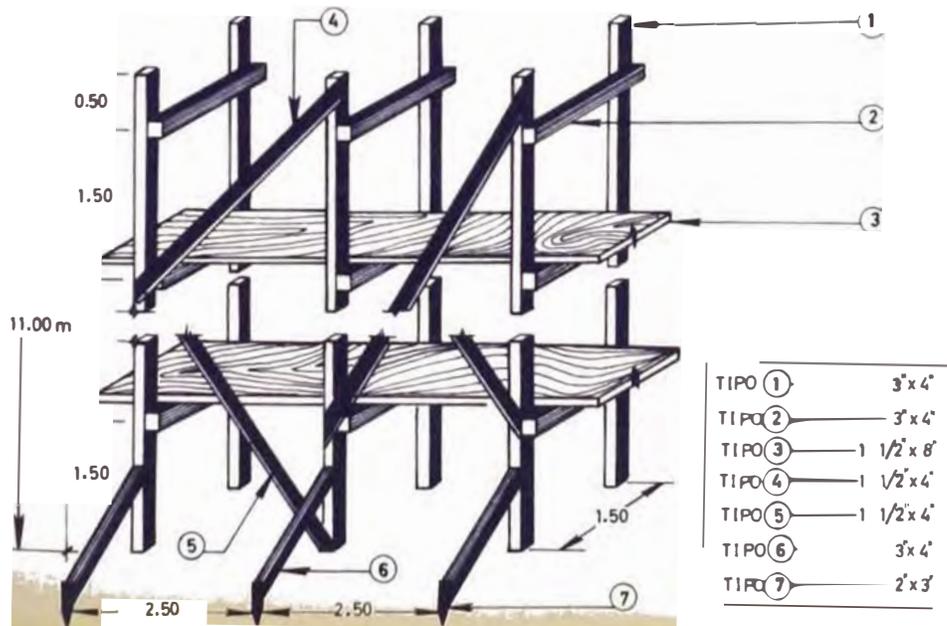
b ANDAMIO DE MURO 1 1/2 LADRILLO CORRIENTE
